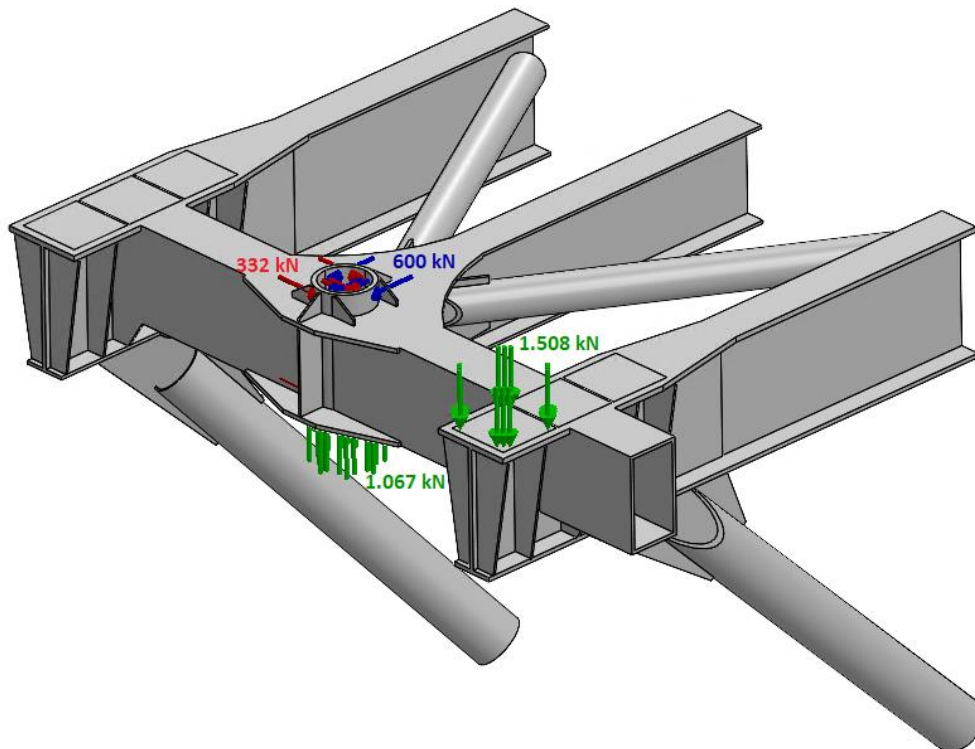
Lastaufbringung Gelenklager B4 – Position 1
